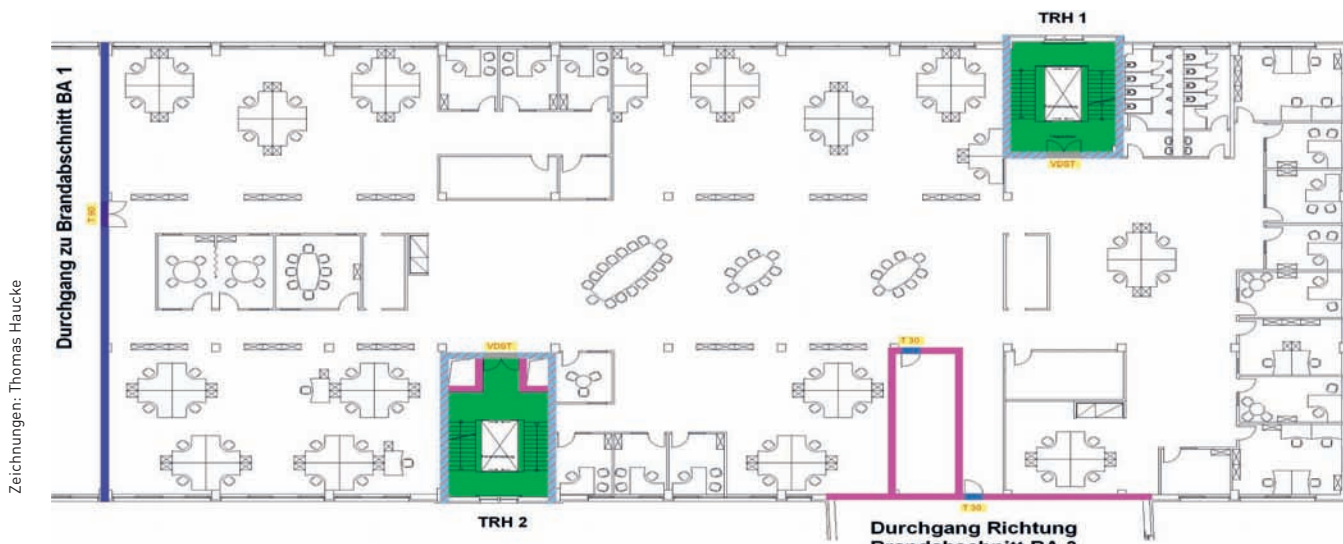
Obergeschoss mit 2.000 m² Grundfläche und einer flächendeckenden Brandmeldeanlage.
